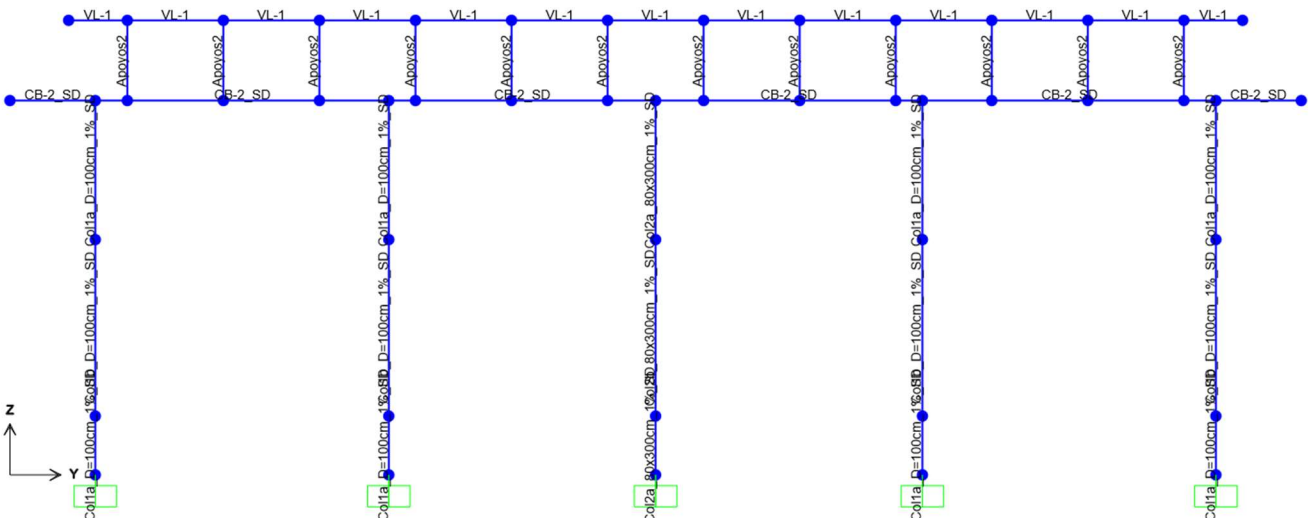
Puente Santo Domingo, elementos estructurales del marco M-4
